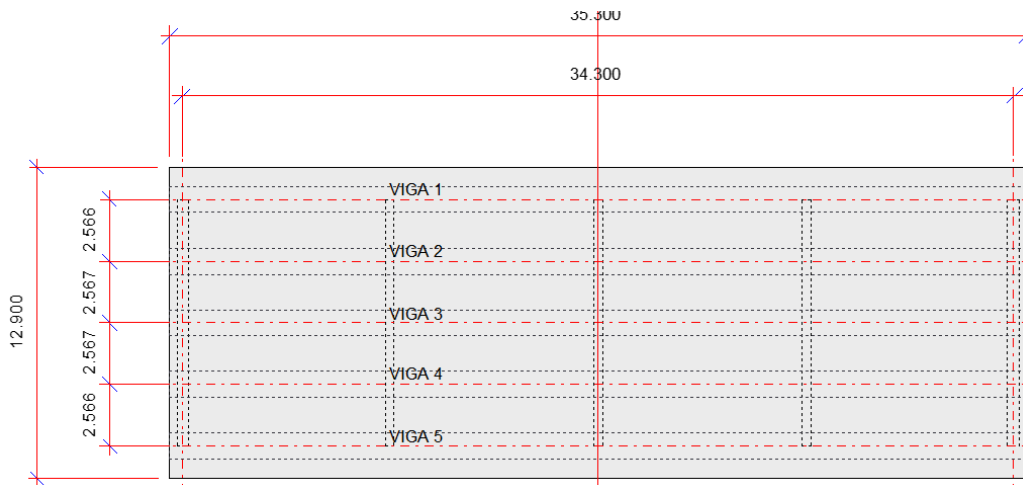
Planta de estructura. Fuente: IDOM-DEHC.
